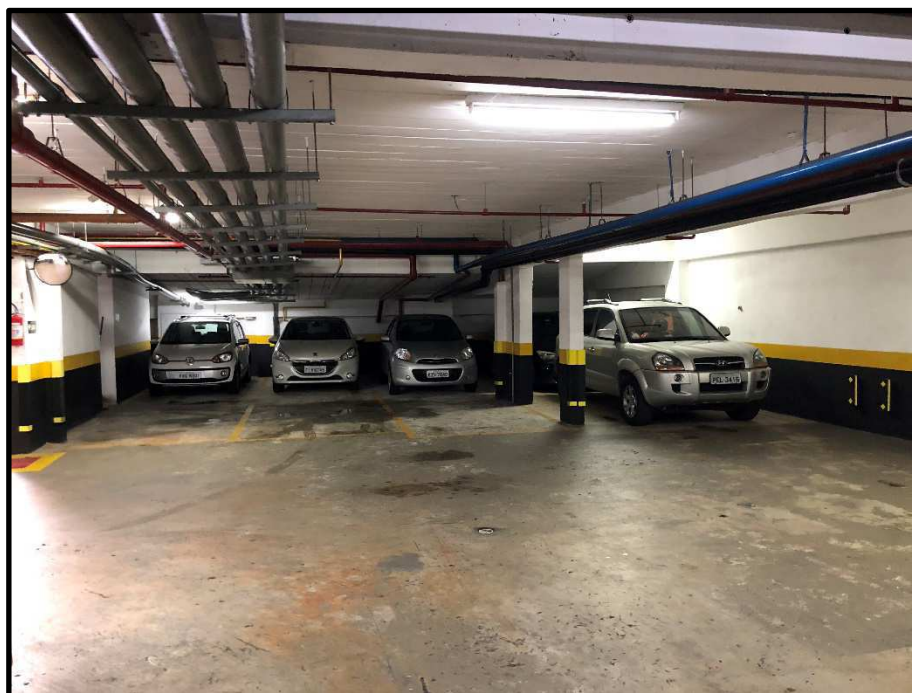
1º subsolo – vagas de garagem – Vista 3
